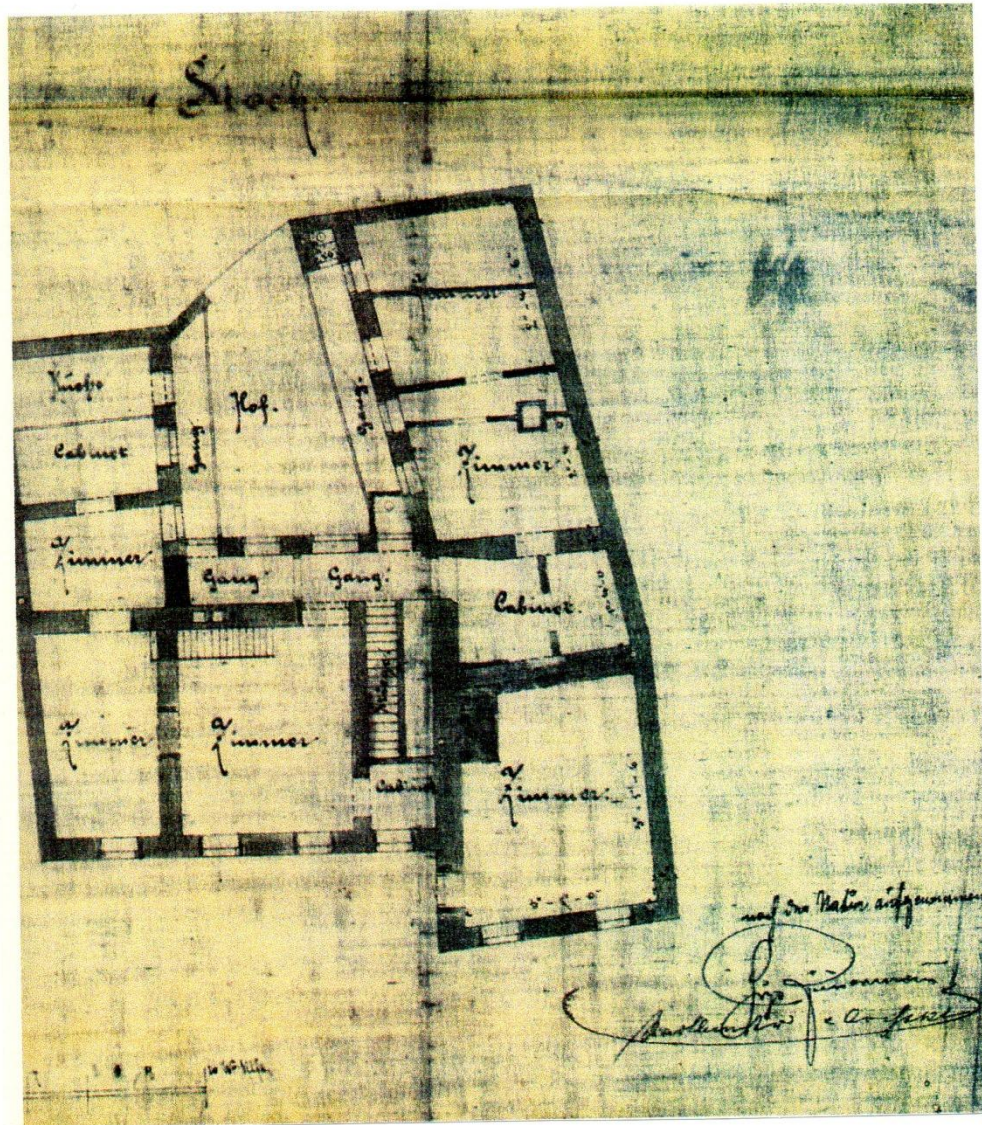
zeigt jene Räumlichkeiten im ersten Stock des Hauses Pfarrgasse 16 im Jahre 1876, in denen rund 100 Jahre davor der Unterricht stattfand.
